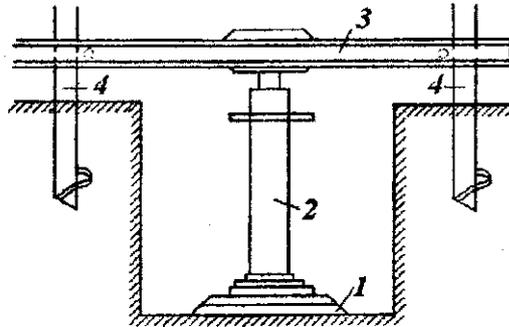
Схема установки для испытания грунтов пробной нагрузкой:
